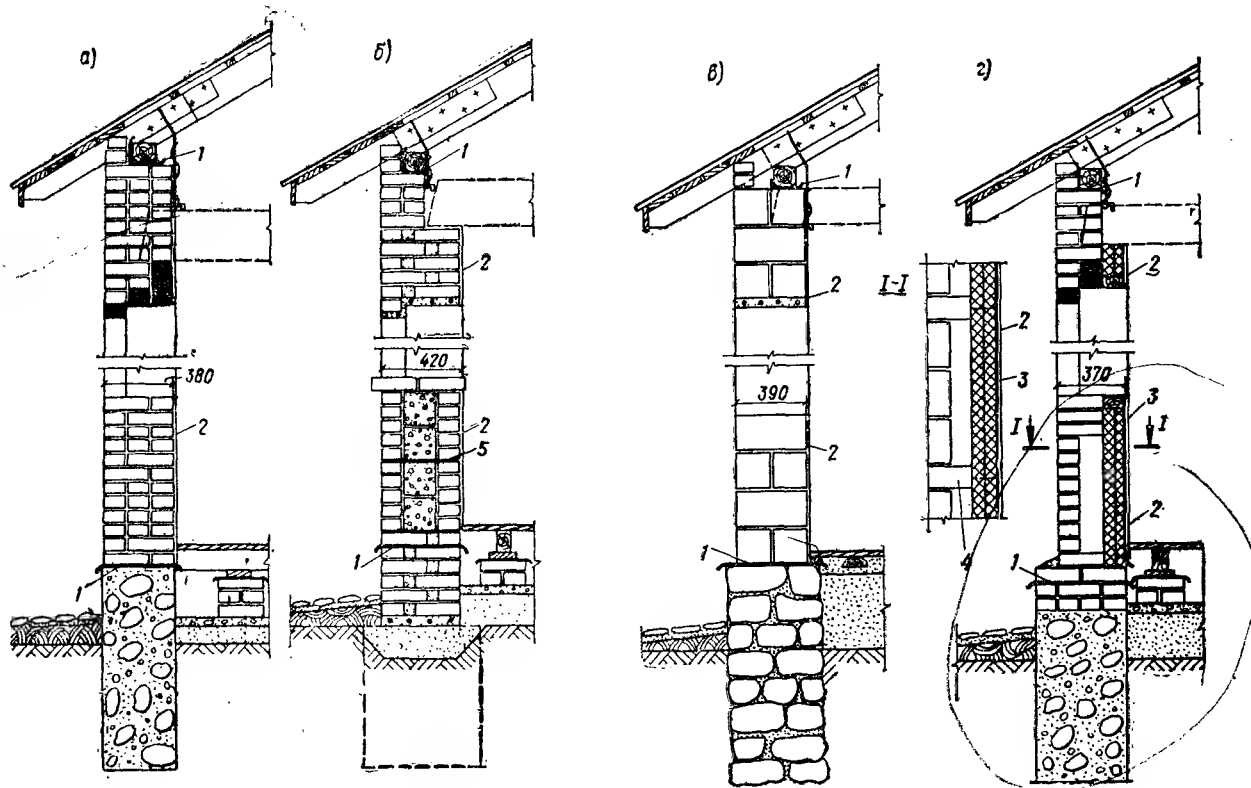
Разрезы наружных несущих стен малоэтажных каменных зданий
